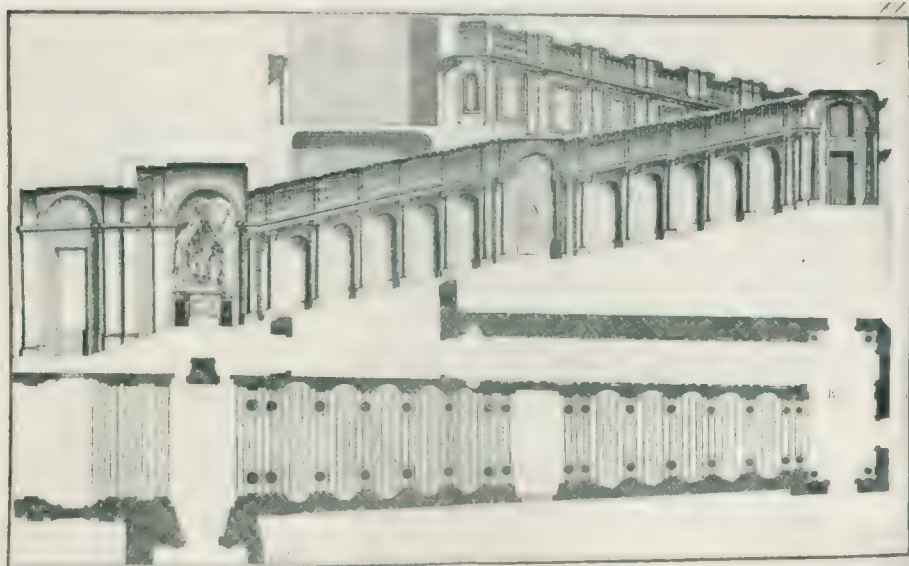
La tavola incisa XX con pianta e sezione della Scala Santa vaticana.
